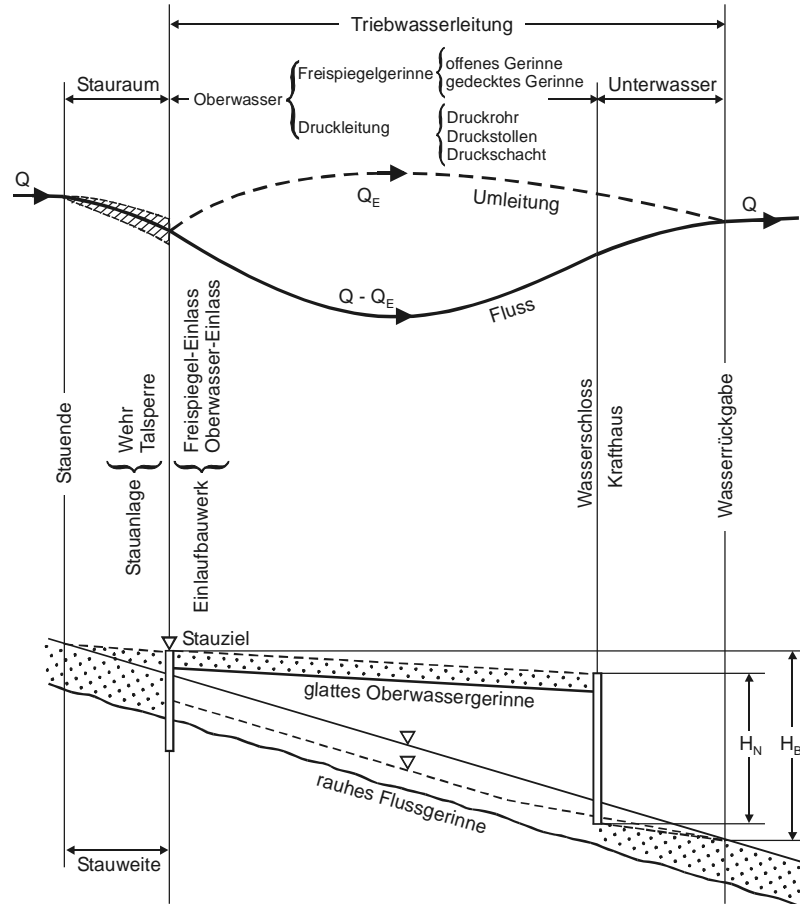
Schema eines Umleitungskraftwerkes im Grundriss (oben) und im Schnitt (unten)
